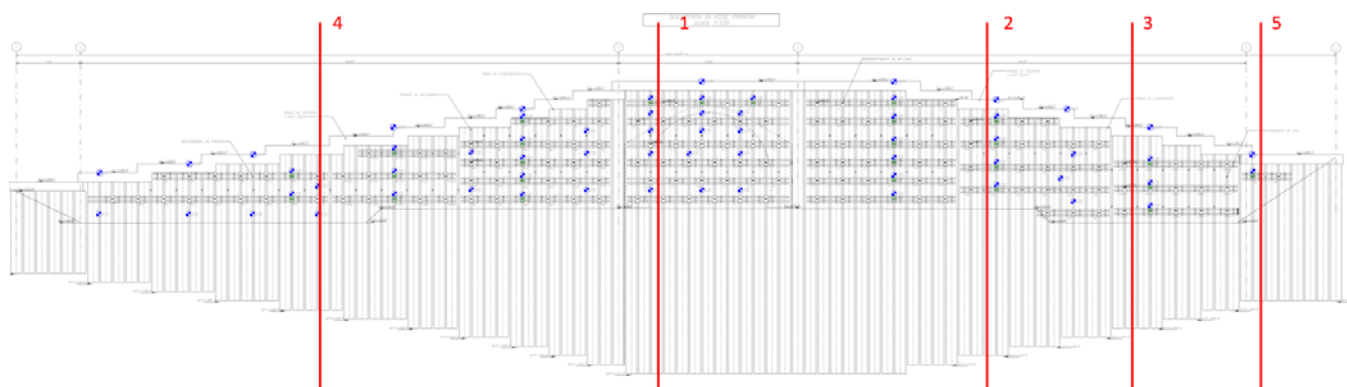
Schema della strumentazione – Prospetto dell'imbocco
